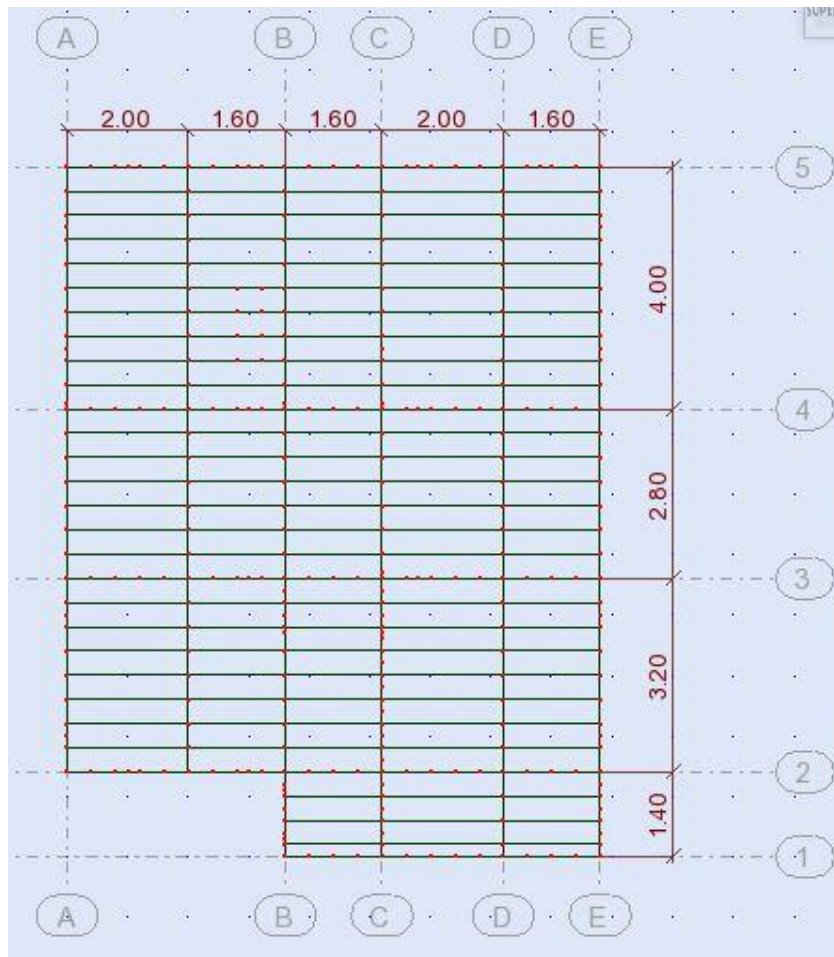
Plano das vigas de piso e da cobertura do pavimento superior.
